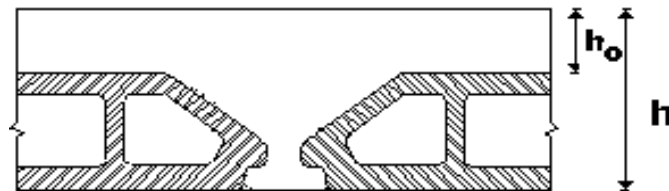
Coupe transversale D'un plancher à corps creux
